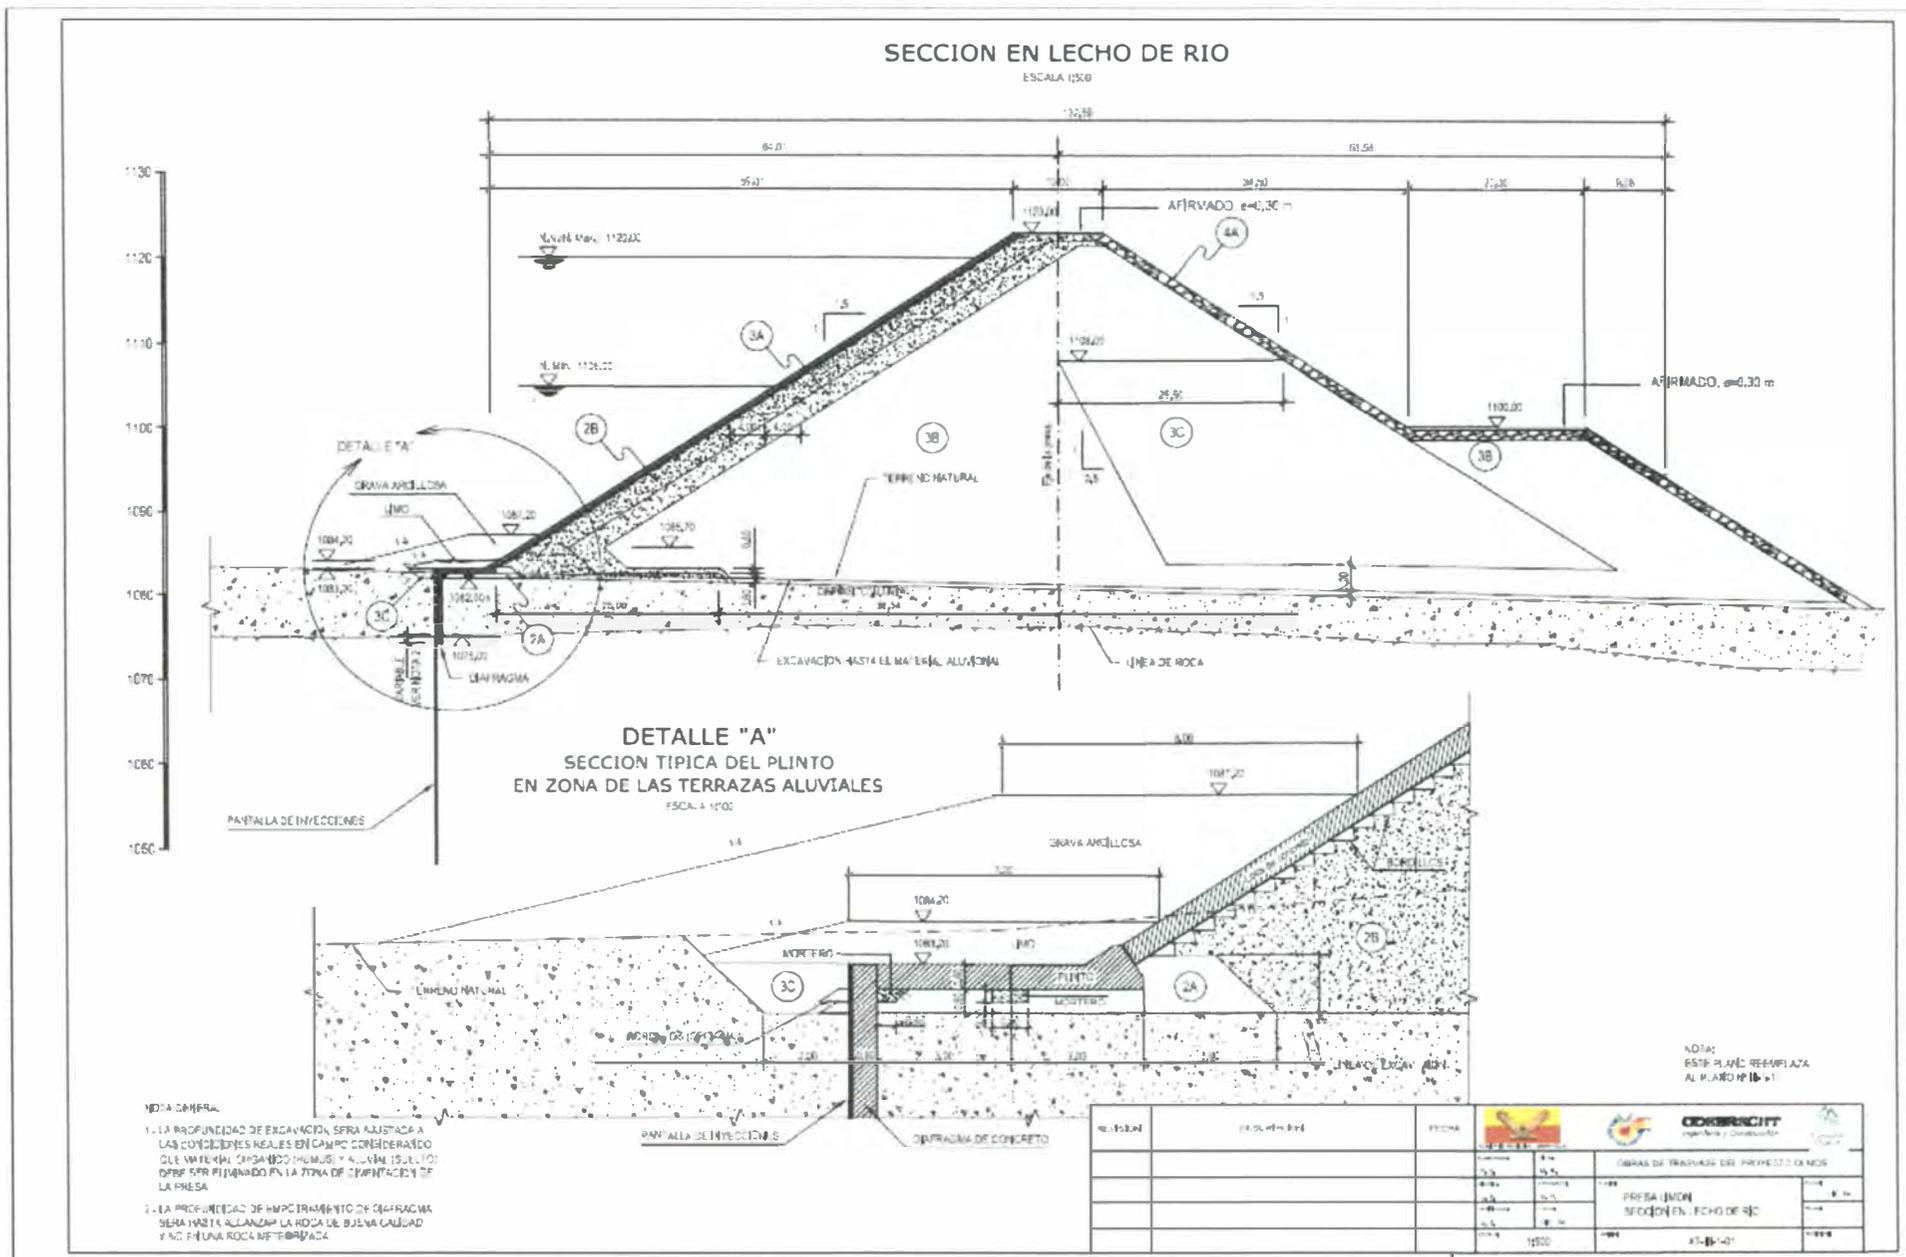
Esquema general de la presa de enrocado y detalle de la zona de apoyo entre la losa y el relleno de presa utilizado en el proyecto Olmos. (Odebrecht Ingeniería y construcción “Expediente Técnico del Proyecto Traslase Olmos - Volumen III”, 2004).
